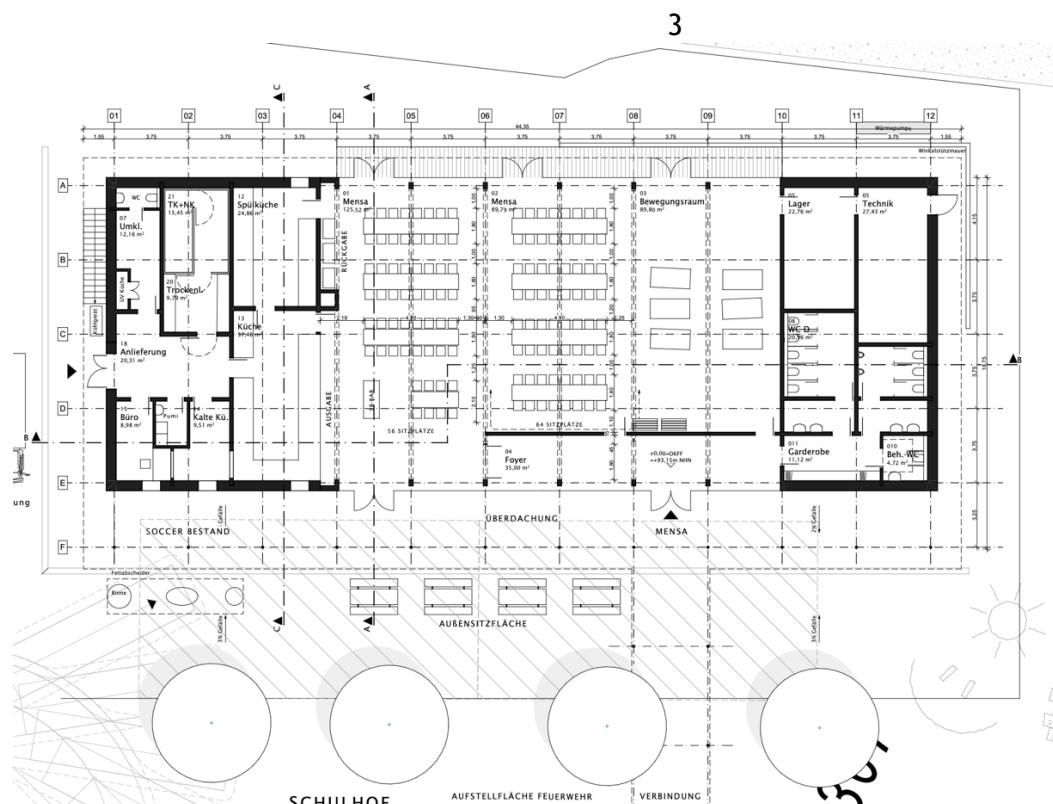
Grundriss Mehrzweckgebäude Marienschule Seppenrade. Quelle: HMW Architekten
